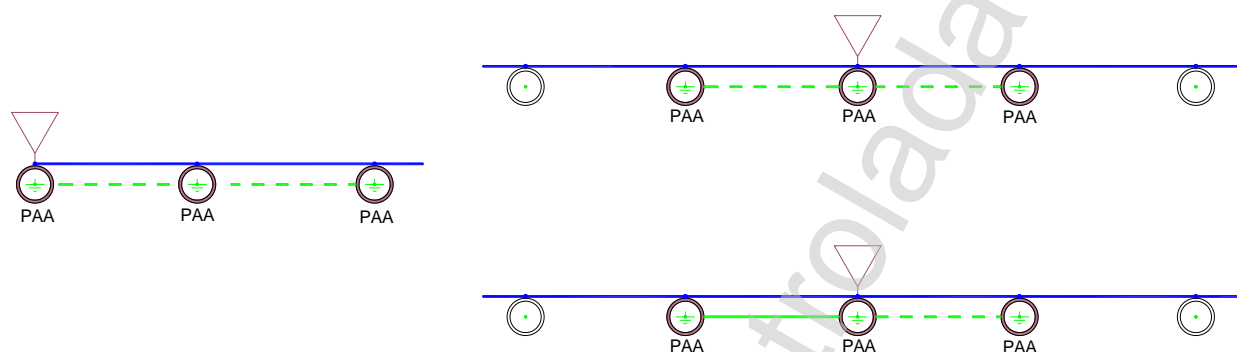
Esquemas de instalação de Postes Auto Aterrado em ET na área rural.
